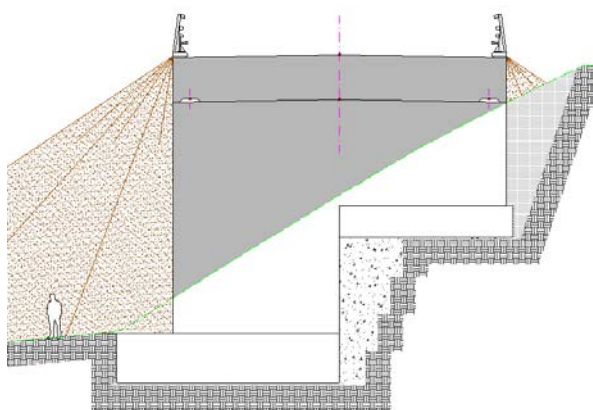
Sección del estribo E2 cimentado en roca escalonadamente.
